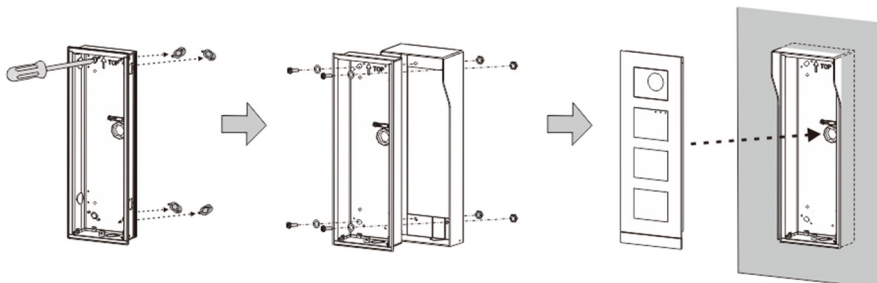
Montaggio a incasso con copertura di protezione contro la pioggia
